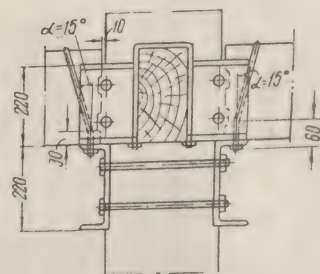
Конструкция металлических консолей на железобетонной колонне:
